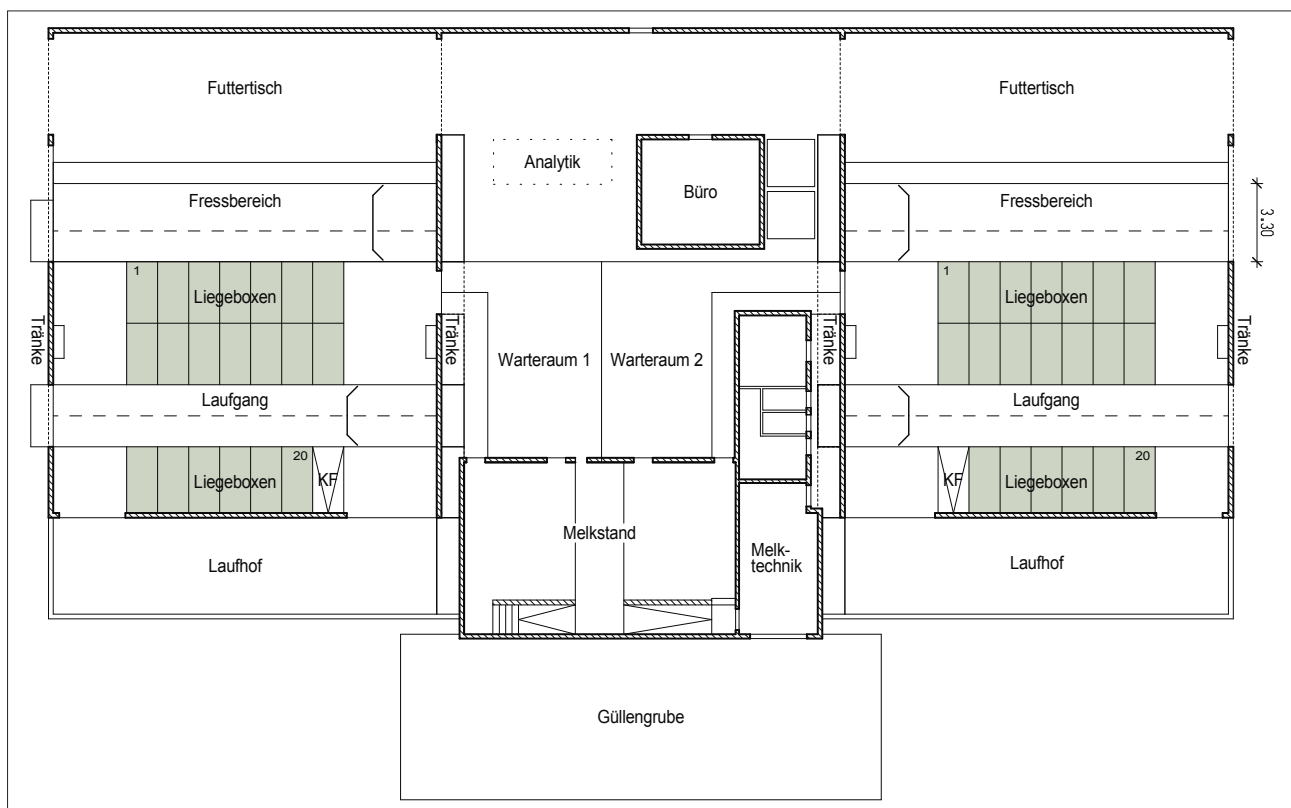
Schematischer Grundriss des Emissionsversuchsstalls mit den Stallabteilen 1 (links) und 2 (rechts) sowie dem Zwischenbereich.
